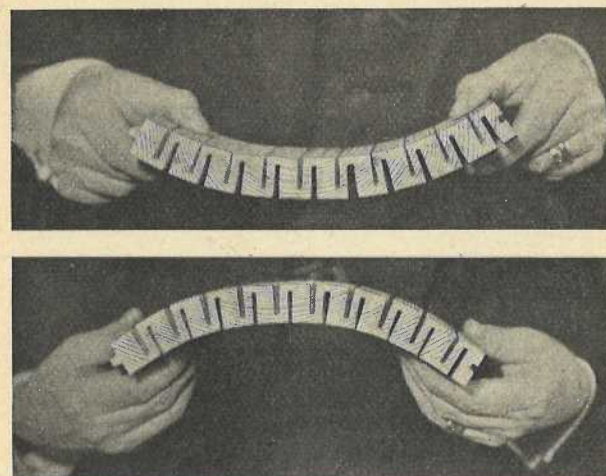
Szczegół konstrukcji elementu wewnętrznego drzwi płytowych, produkowanych masowo przez „Starachowice” w Warszawie.
